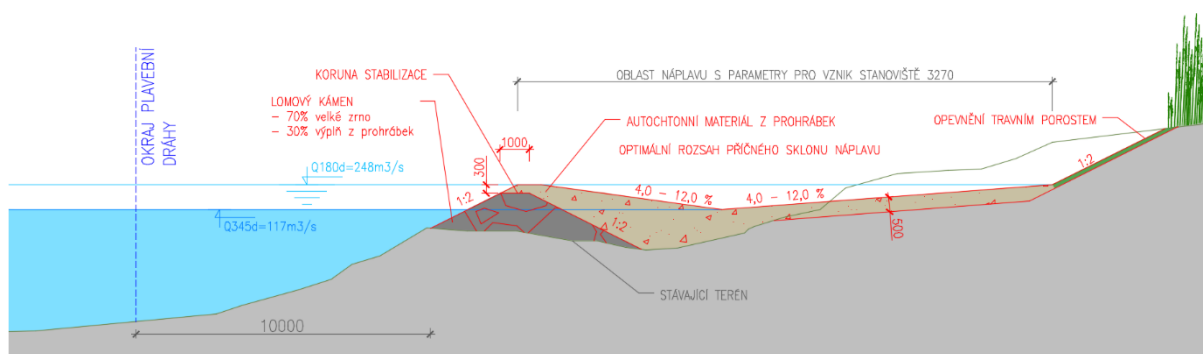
Situace náplav se stabilizační patou - protékaná varianta
